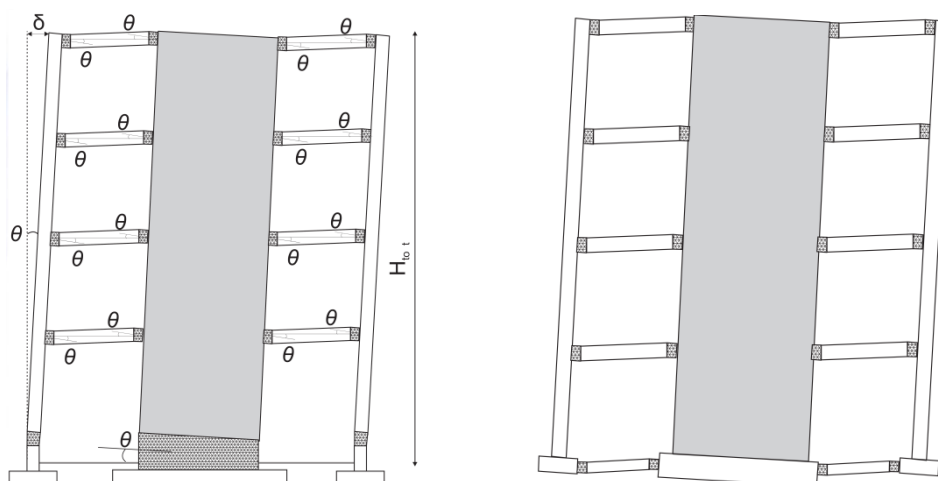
Mecanismo parede viga (Fardis, 2008)
